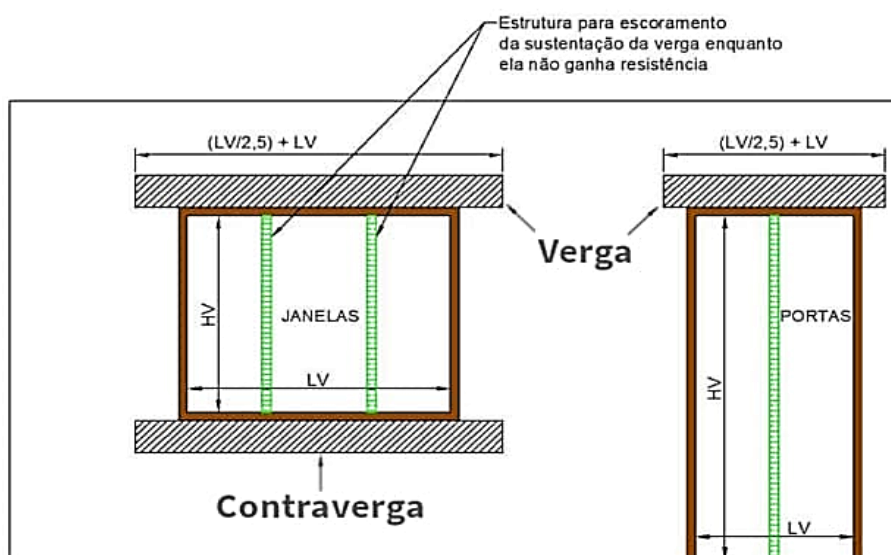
Cálculo de comprimento de Vergas e Contravergas
